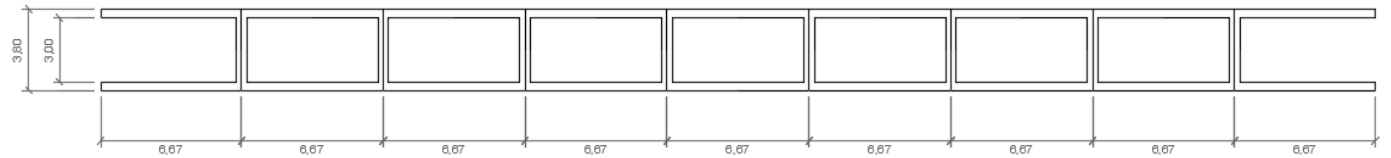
Dimensiones generales en planta de la pasarela (arcos y riostras)
